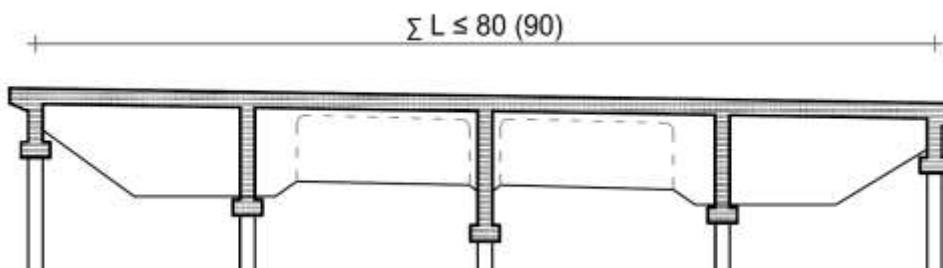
Shema integralne betonske konstrukcije nadvožnjaka sa tri raspona
